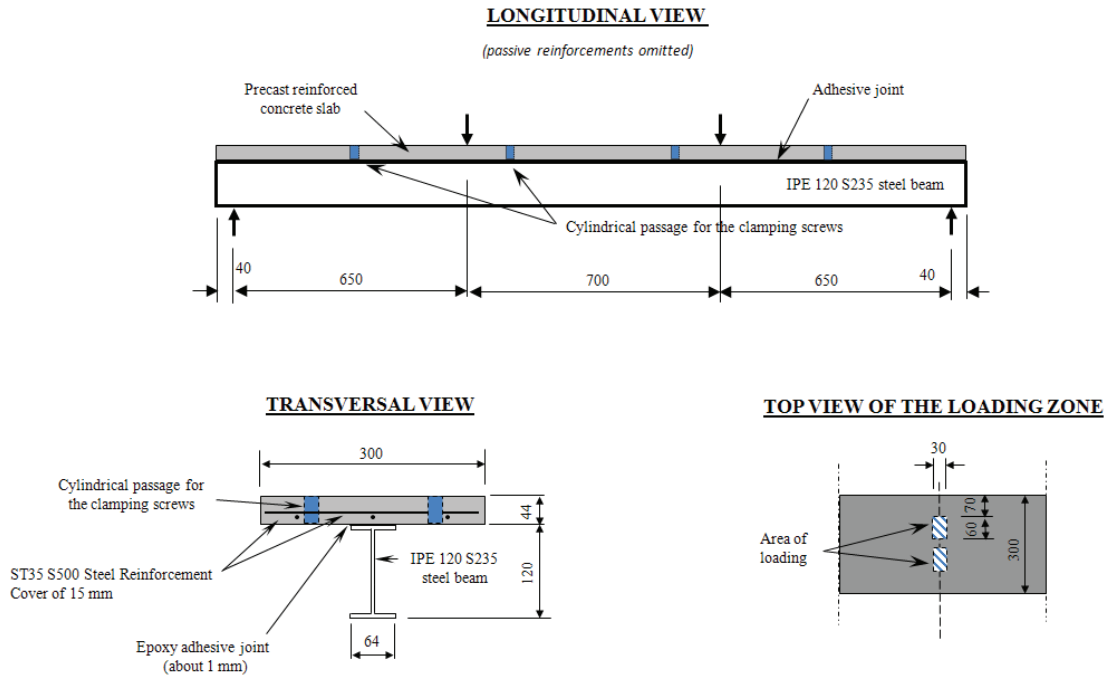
Géométrie, ferrailage et chargement de la poutre AB4
